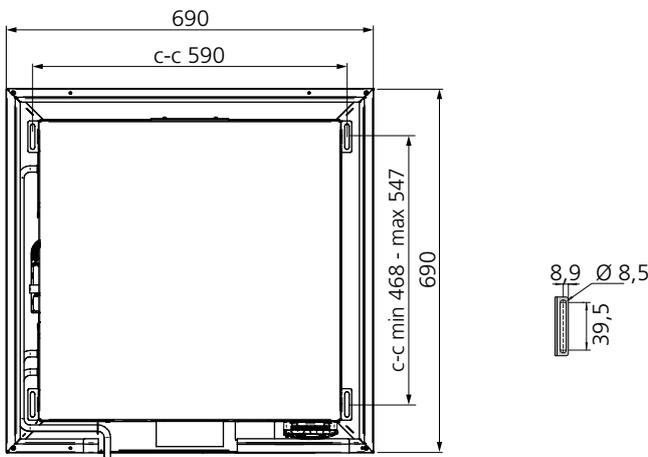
ADAPT Parasol EX 690, Draufsicht
